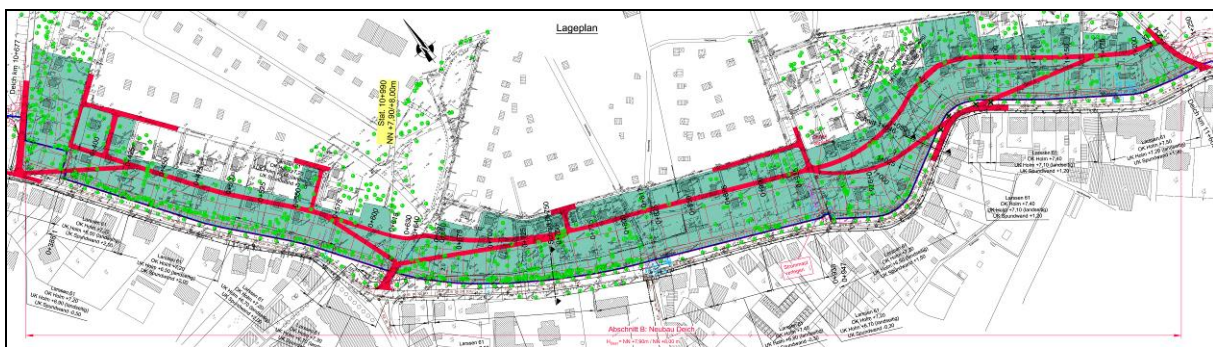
Rahmenentwurf Abschnitt B – Ausschnitt Lageplan (IL 2013)
